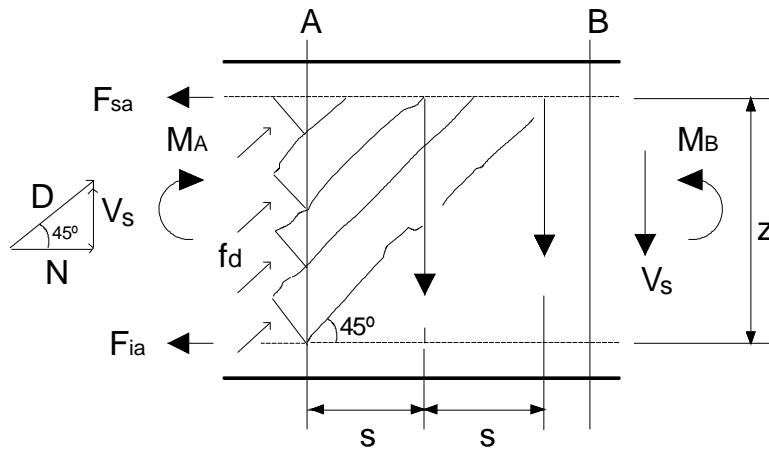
Diagrama de cuerpo libre de una sección de concreto reforzado
